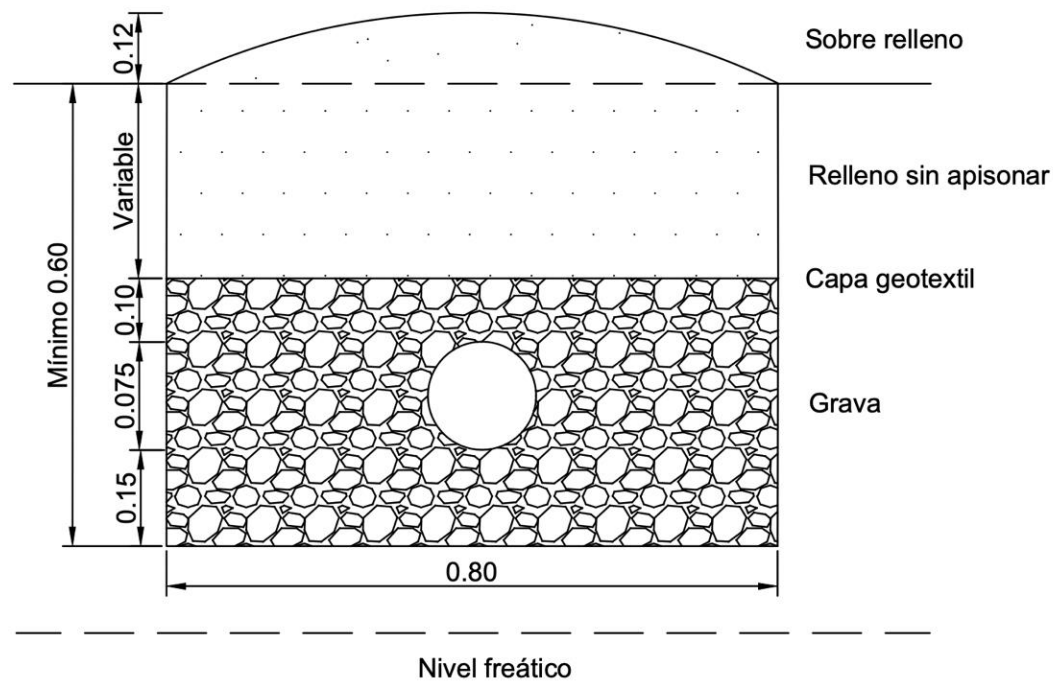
Zanja de infiltración sección transversal. Fuente. Gamboa, 2023.
